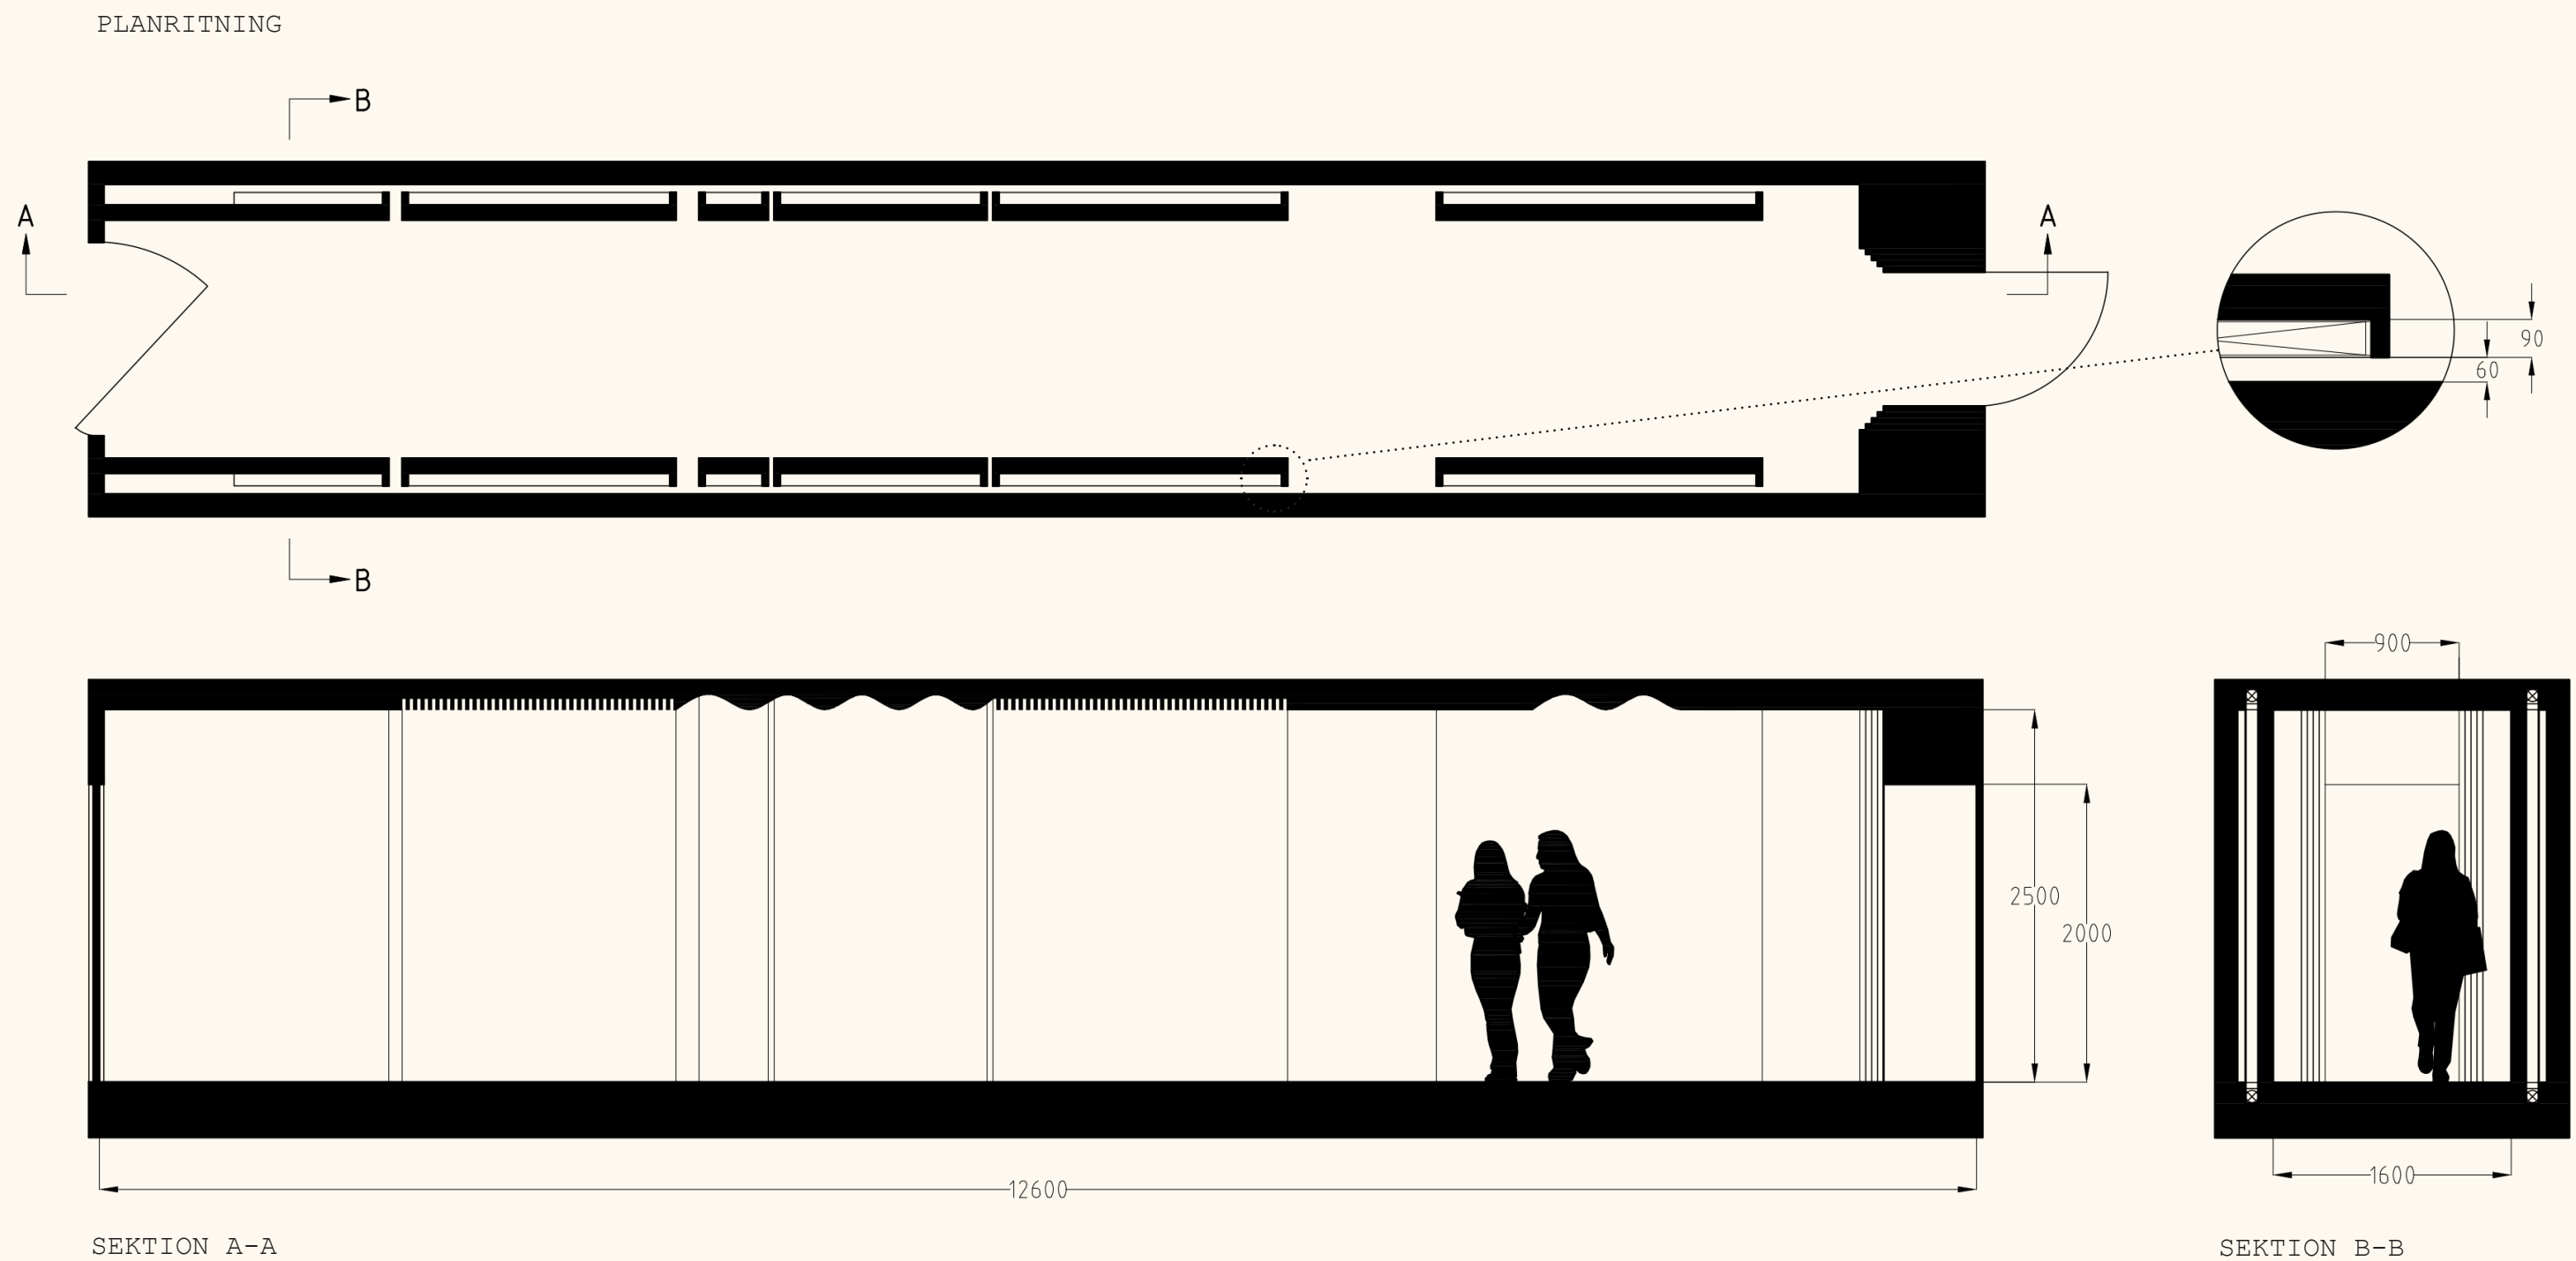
Planritning, detalj samt två sektioner som visar utformning och måttsättning.
